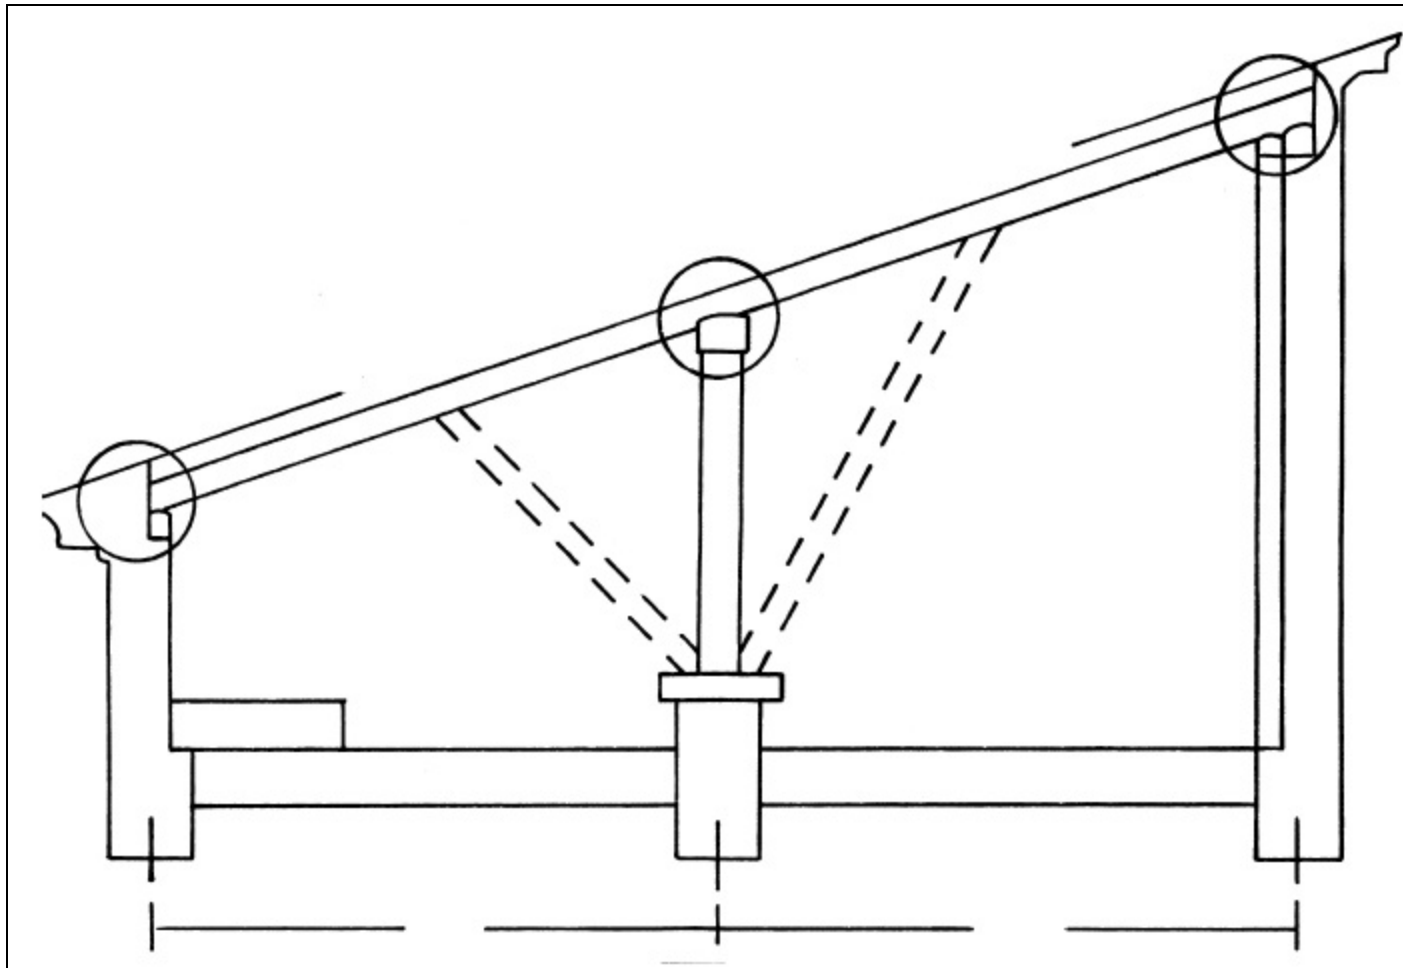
, а) показана стропильная нога с подкосом, опертым на мауэрлат, положенный на обрез стены на уровне верха чердачного перекрытия.
